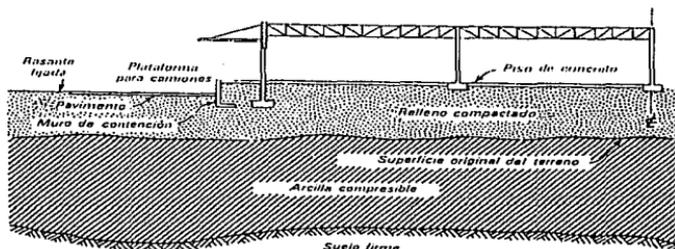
Sección Transversal en un edificio para industria ligera sobre suelo compactado.
